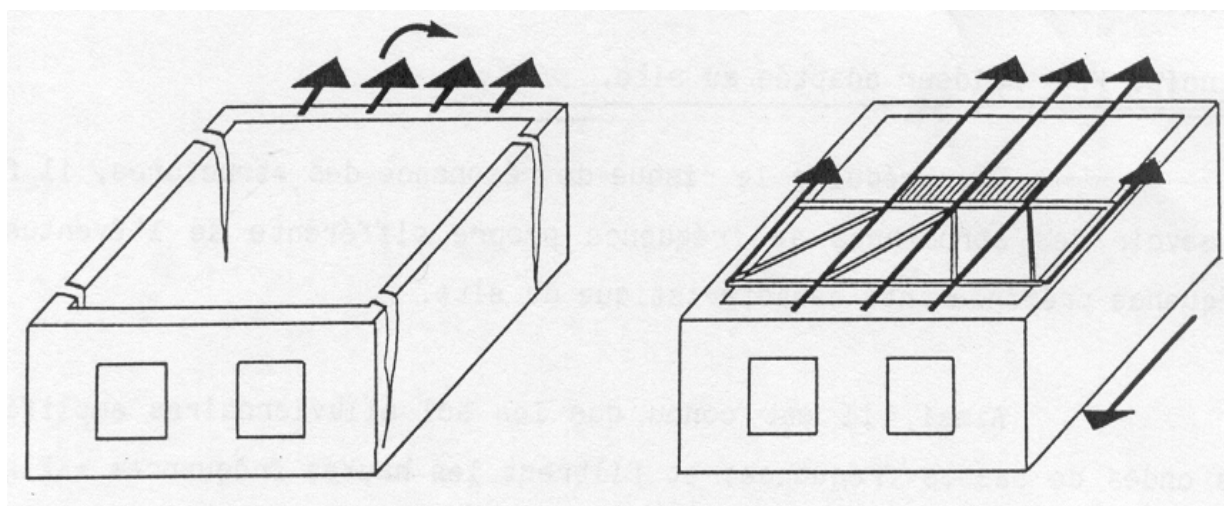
Rôle des planchers sous action sismique : former des diaphragmes pour assurer la cohésion de la structure (Plumier, 1992)
